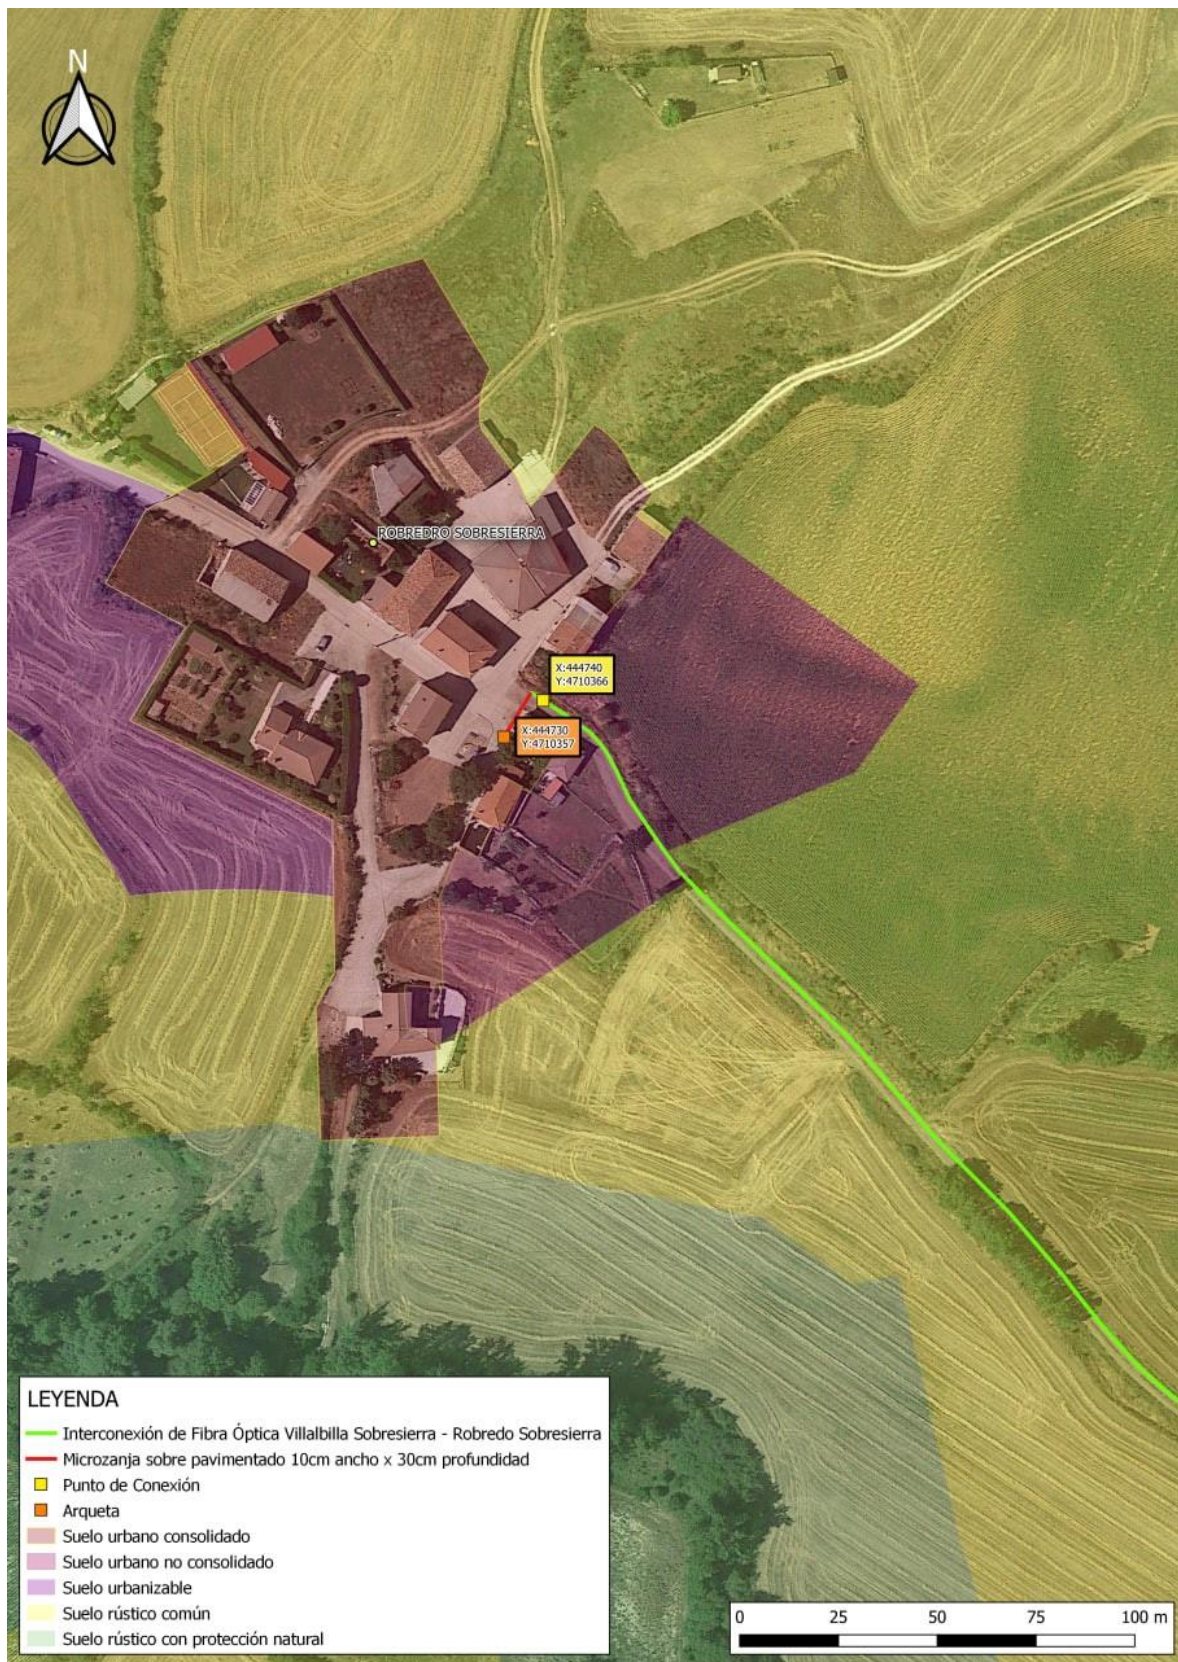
PLANO EMPLAZAMIENTO ENTRADA ROBREDO SOBRESIERRA.
